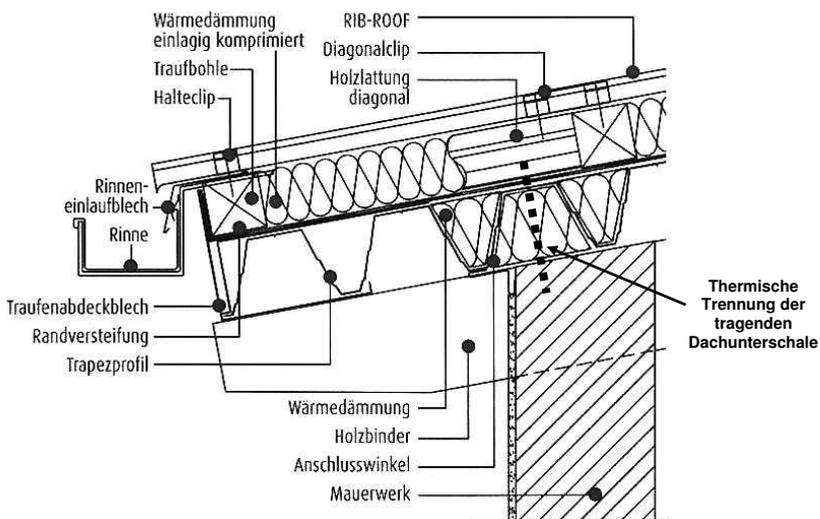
Traufausbildung mit Dachüberstand bei einer Klemmfalzprofildeckung
